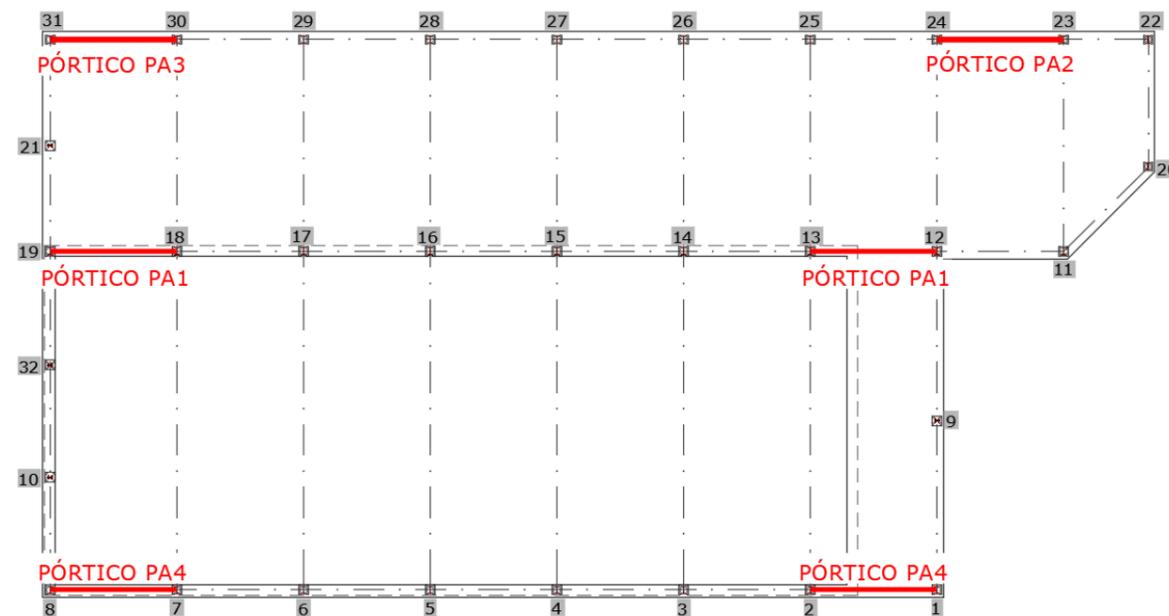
Pórticos de la estructura metálica que no cuentan con las cruces de San Andres. Elementos a reponer.
